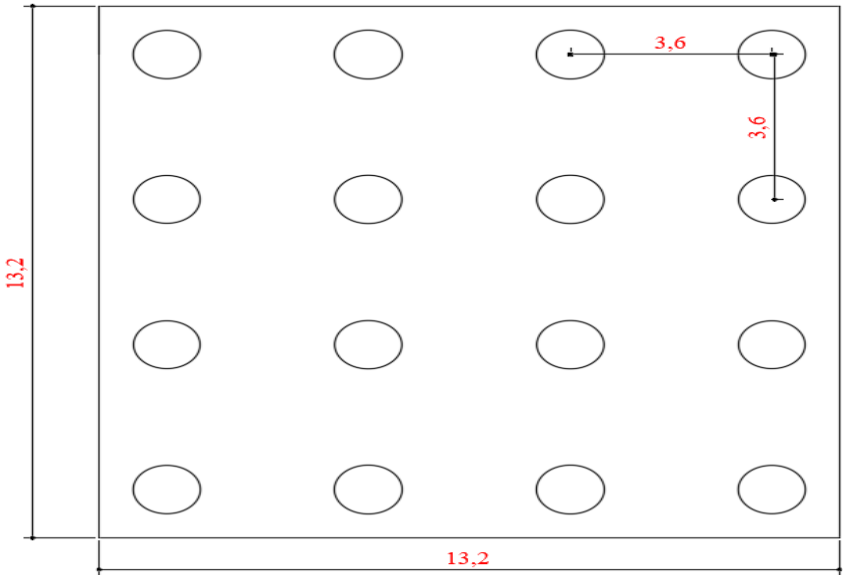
Dispositions des pieux (semelle sous la pile).
